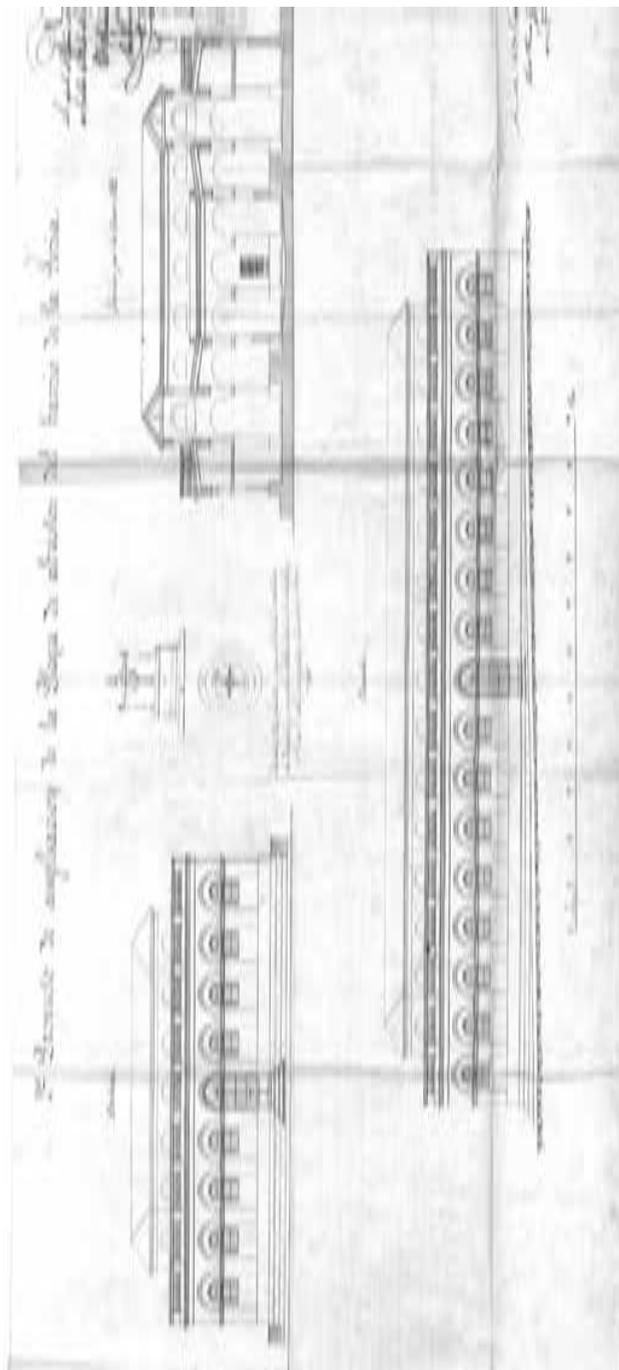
Proyecto para el mercado de la Feria: sección y alzados. B. Marrón. 1862 (AHMS).
